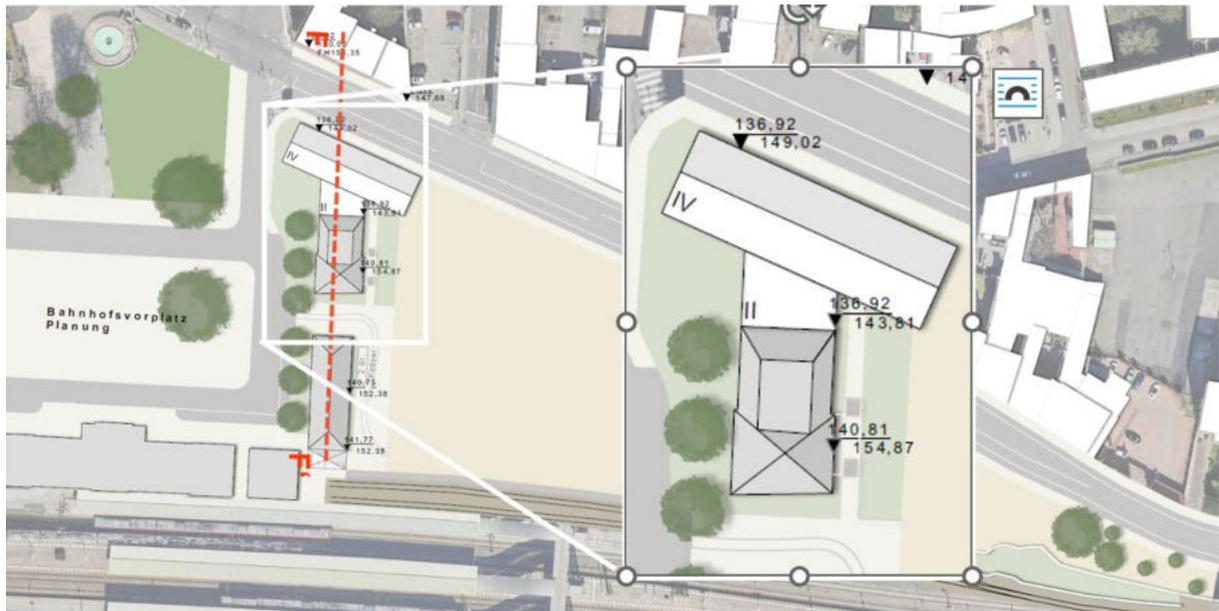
Entwurfsvariante 2.4 - Baufeld West - Fortführung der Bestandsbebauung, Zeilenstruktur Landauer Straße
